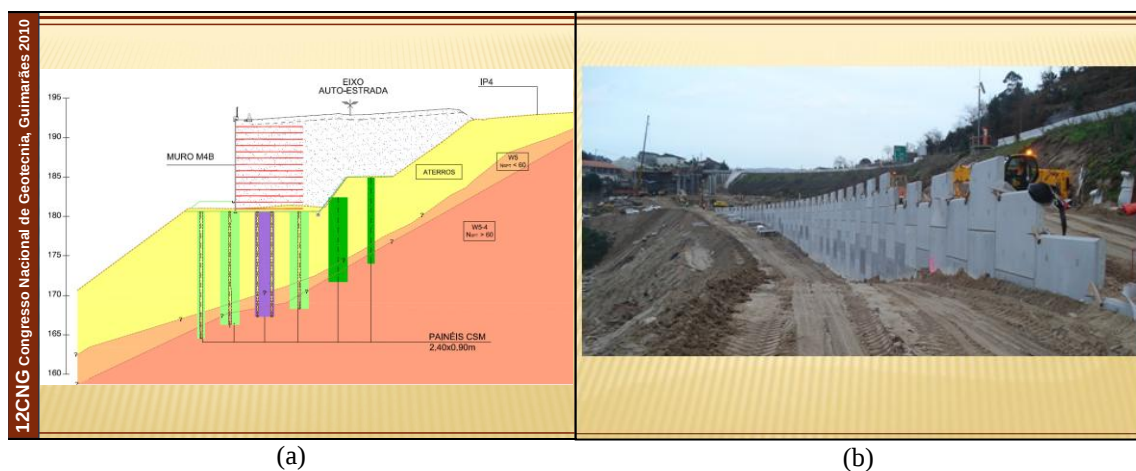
Corte transversal do muro M4B na zona onde foi realizado o tratamento do terreno de fundação e vista do muro de terra reforçada
